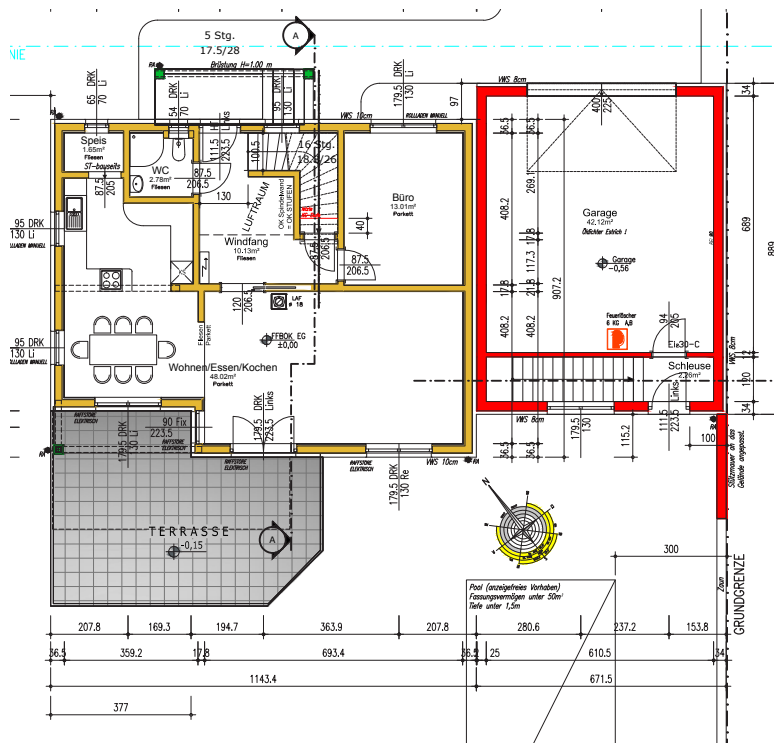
Beispielhaus 2. Gartenansicht und Grundriss
